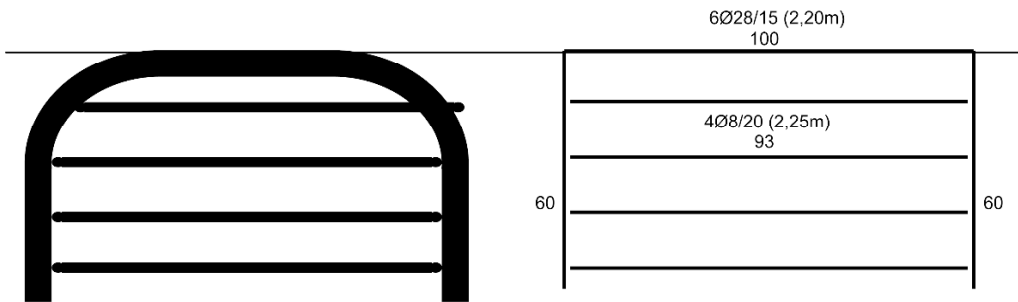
Geflechtaufbau (links) mit den tatsächlichen Maßen nach der Zeichnungsvorgabe (rechts)
